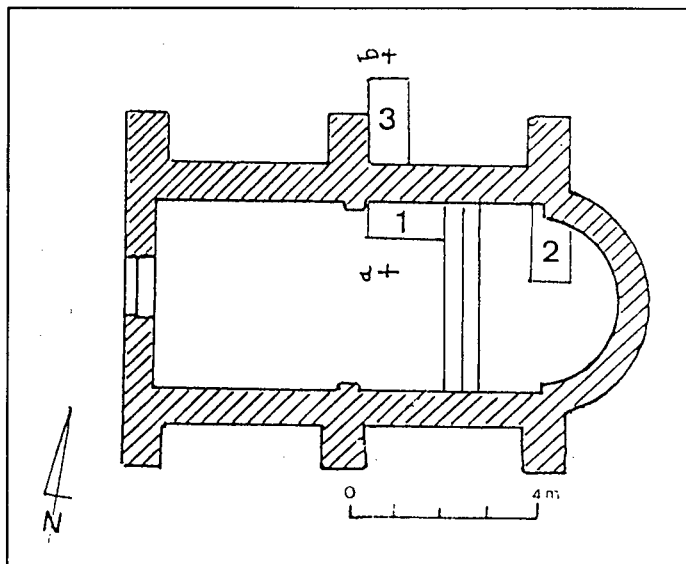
GEMENOS, Chapelle Saint-Martin. Plan de la chapelle. (dessin Jean-Baptiste Féraud)
